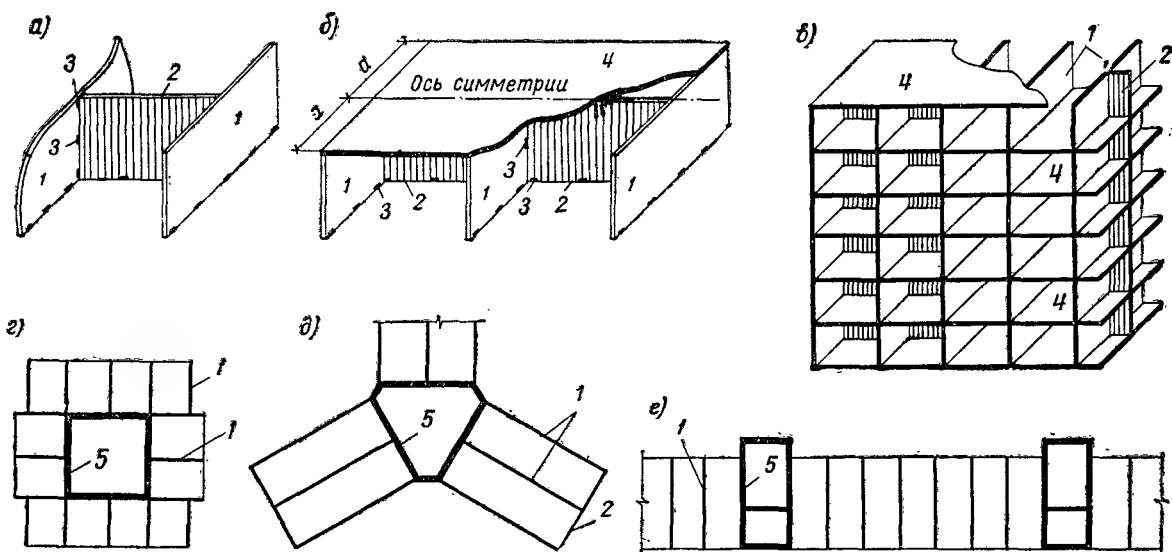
Обеспечение устойчивости крупнопанельных зданий
